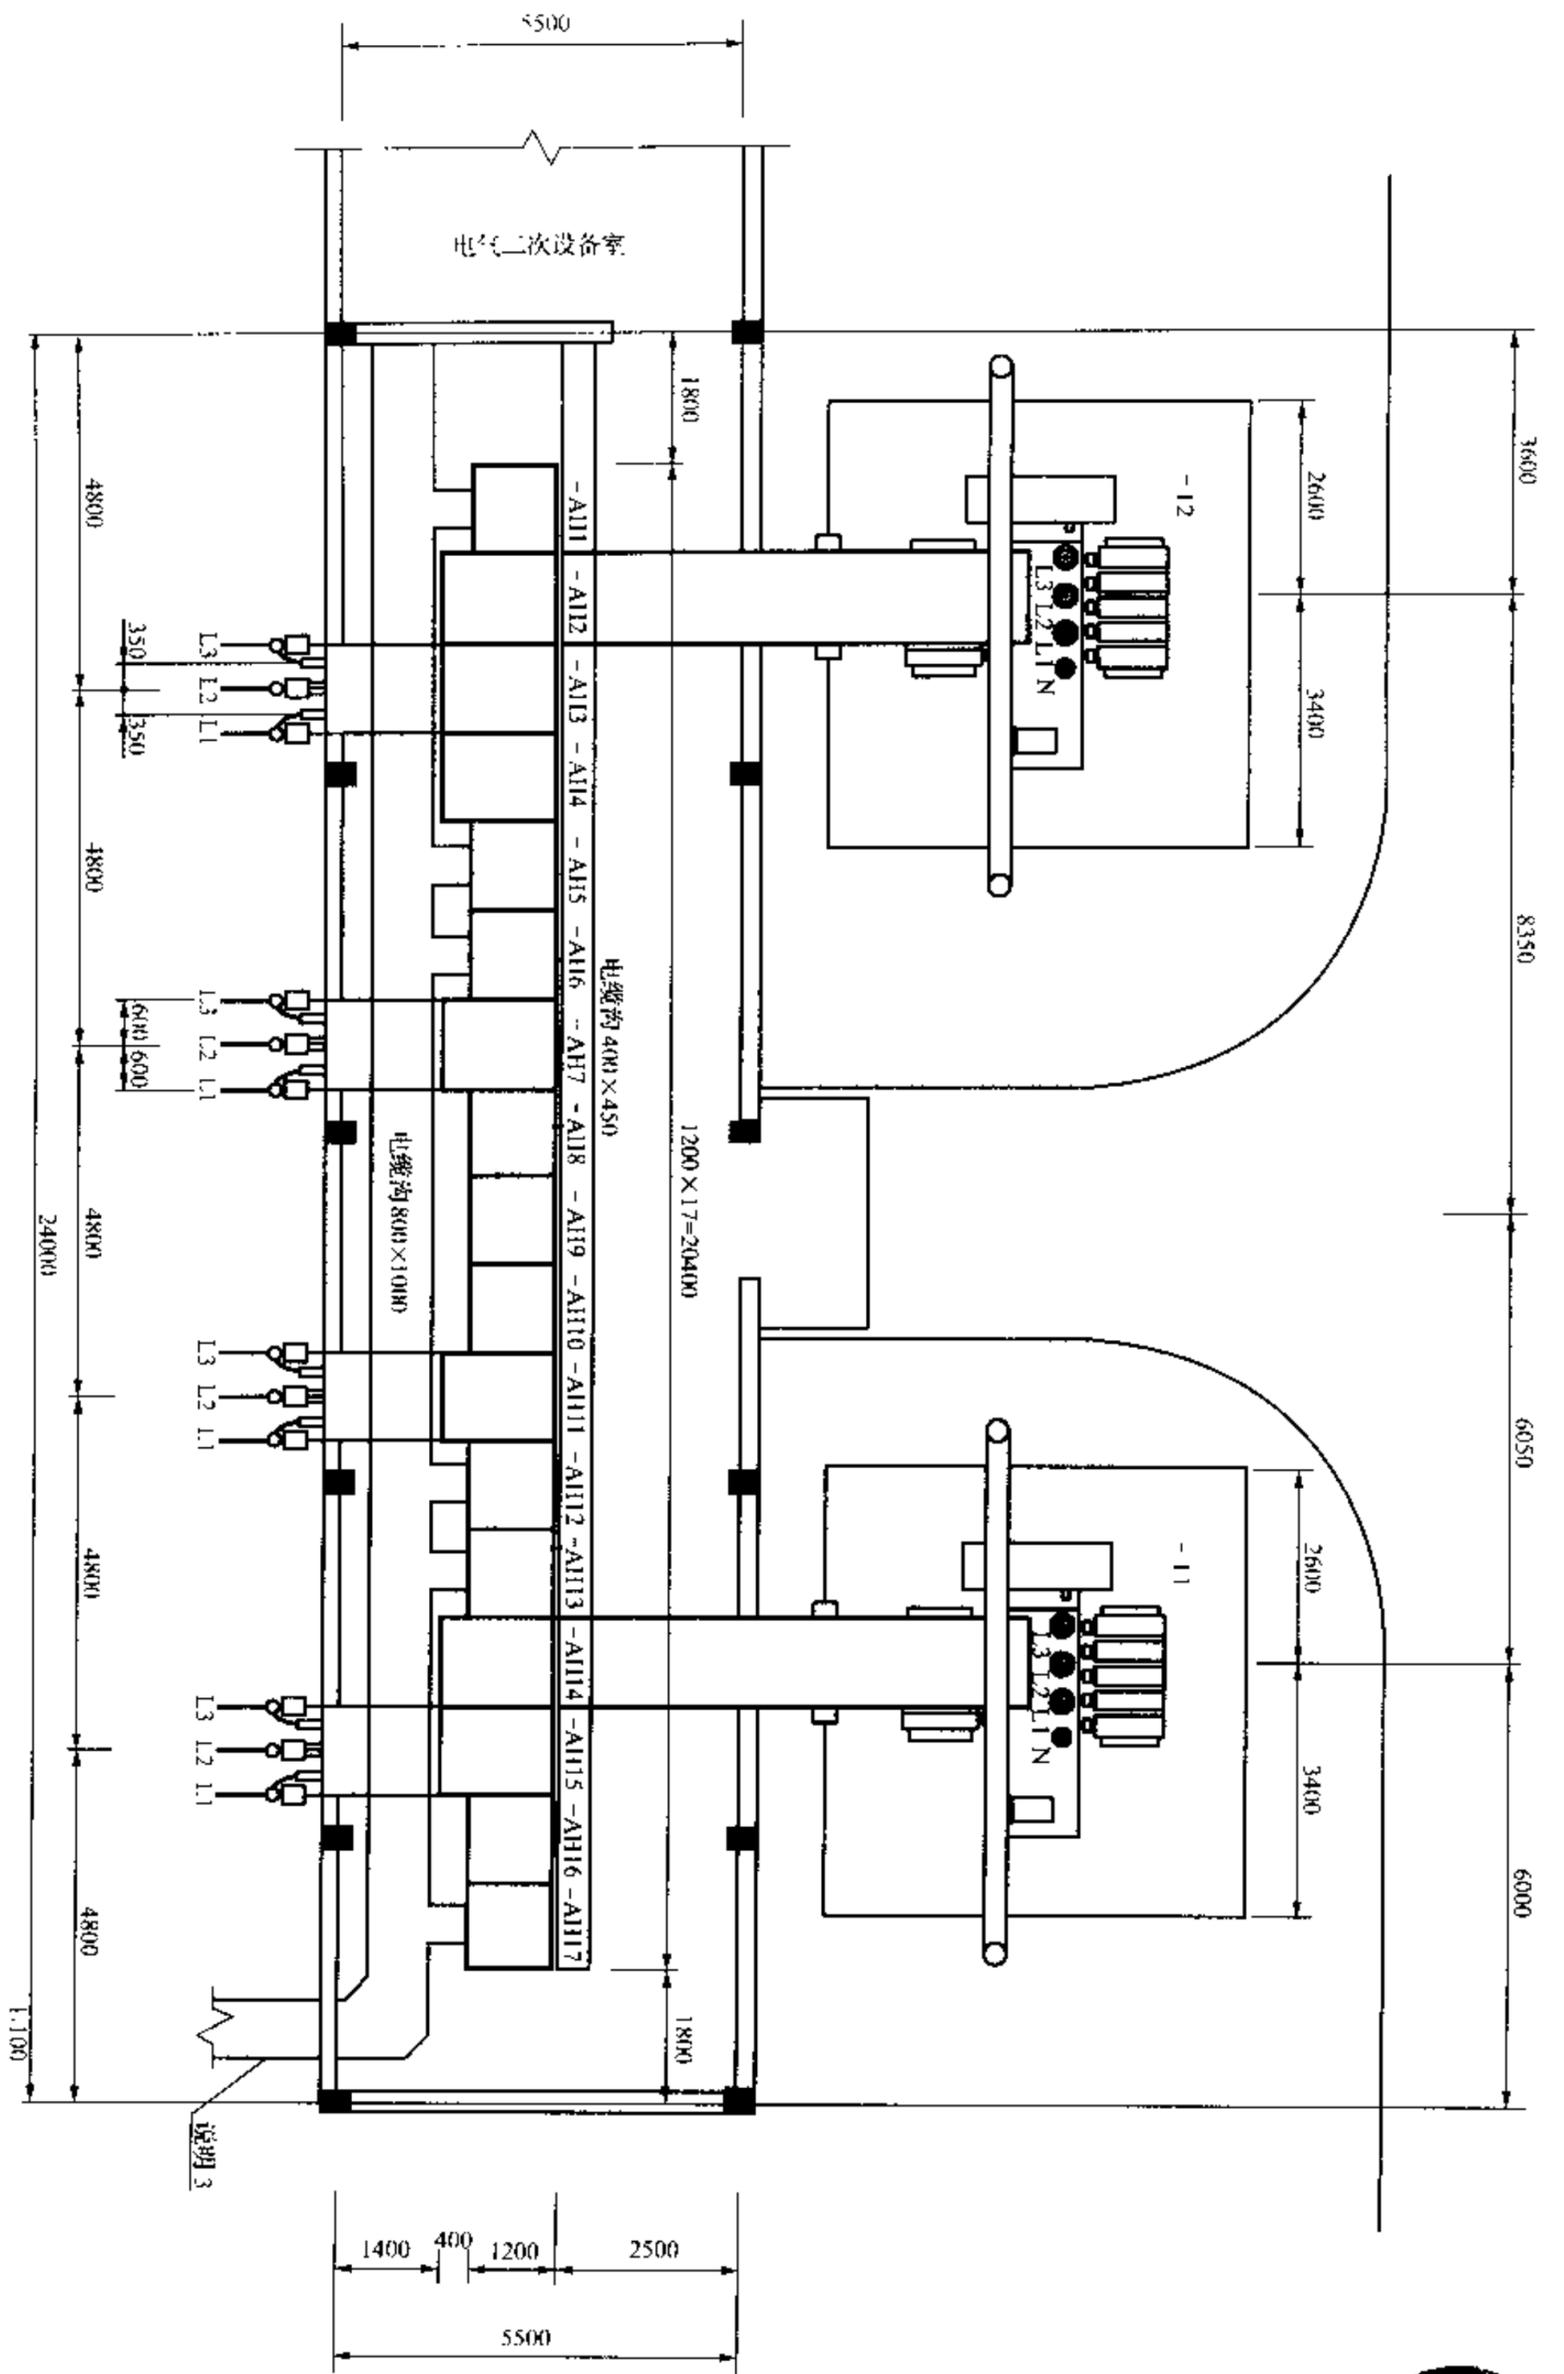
10 kV 屋内配电装置平面布置图 (一)
